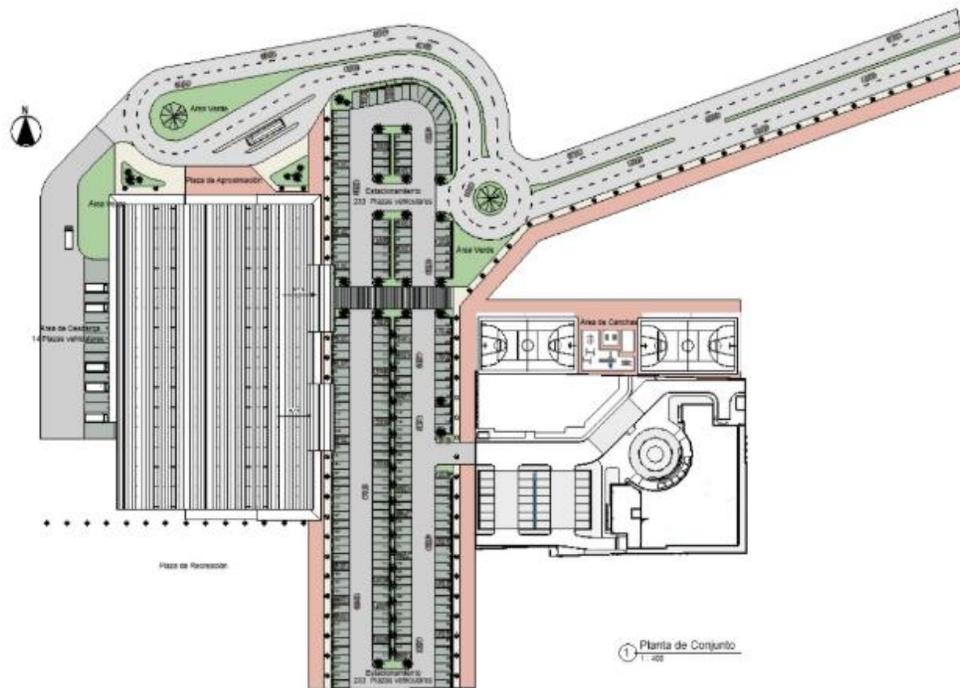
Planta de Conjunto Mercado Chamelecón
